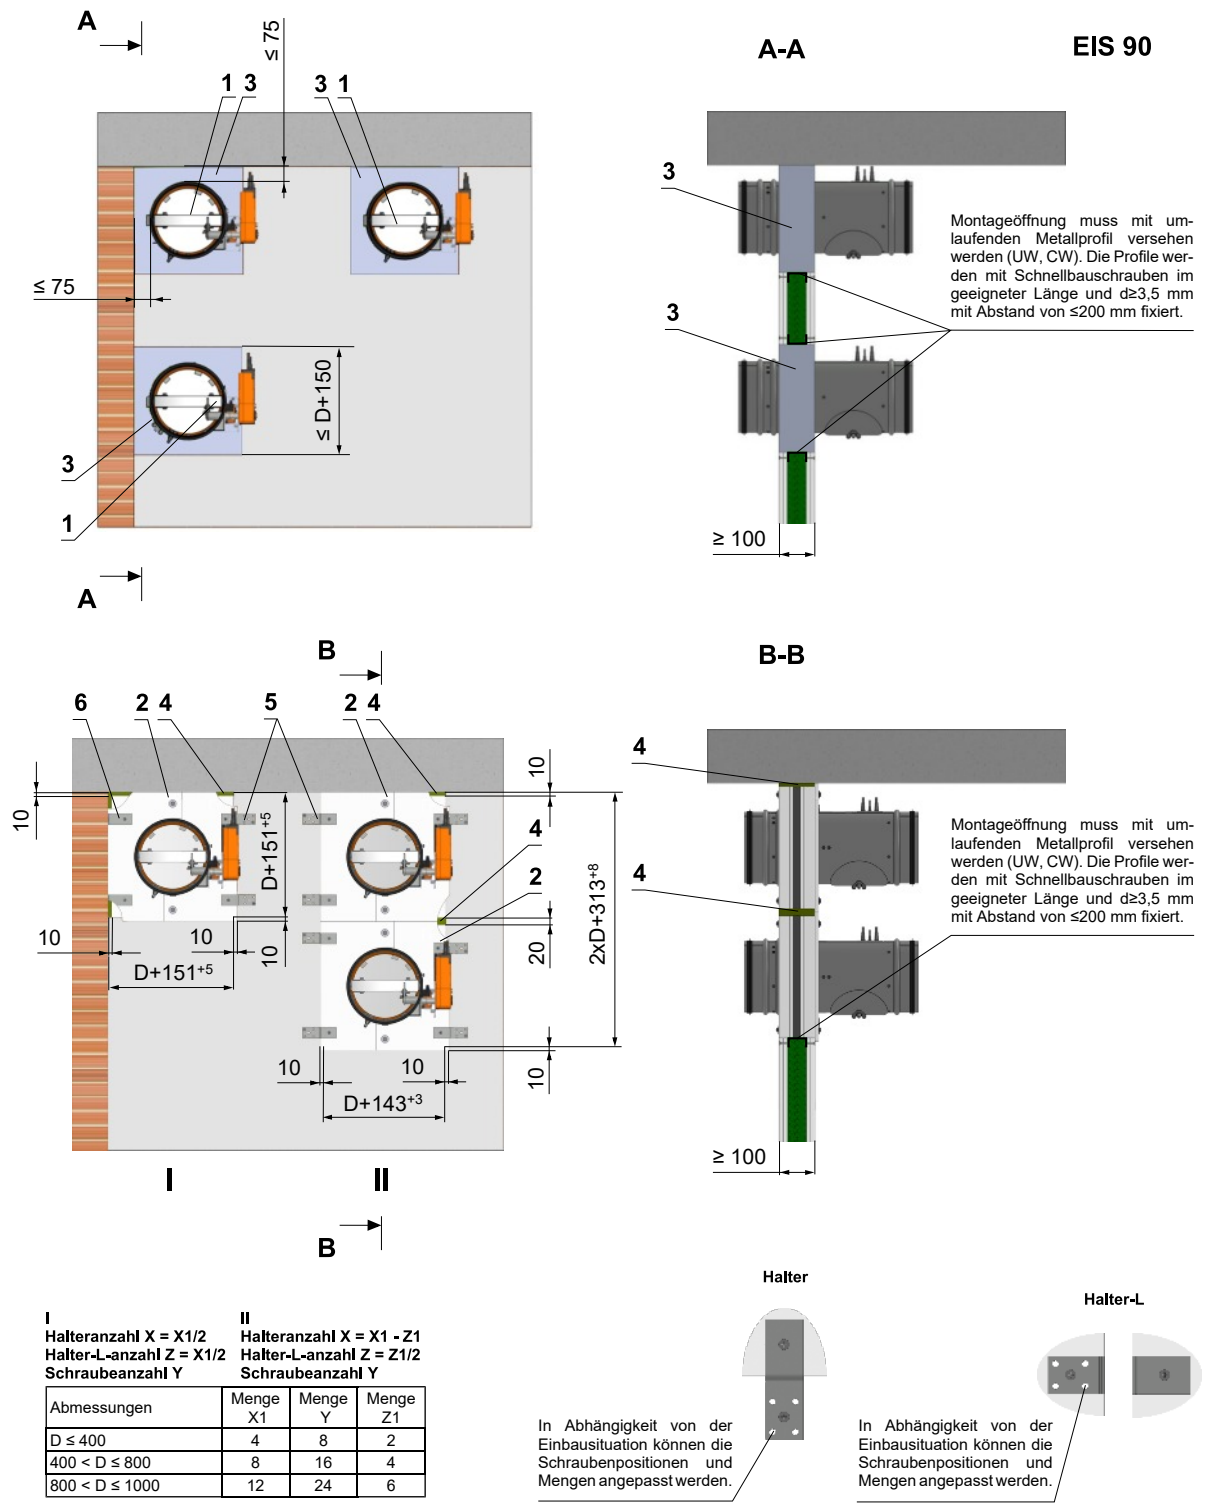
Leichtbauwand - Einbau Wand, Decke - Gips oder Mörtel und Mineralwolle
